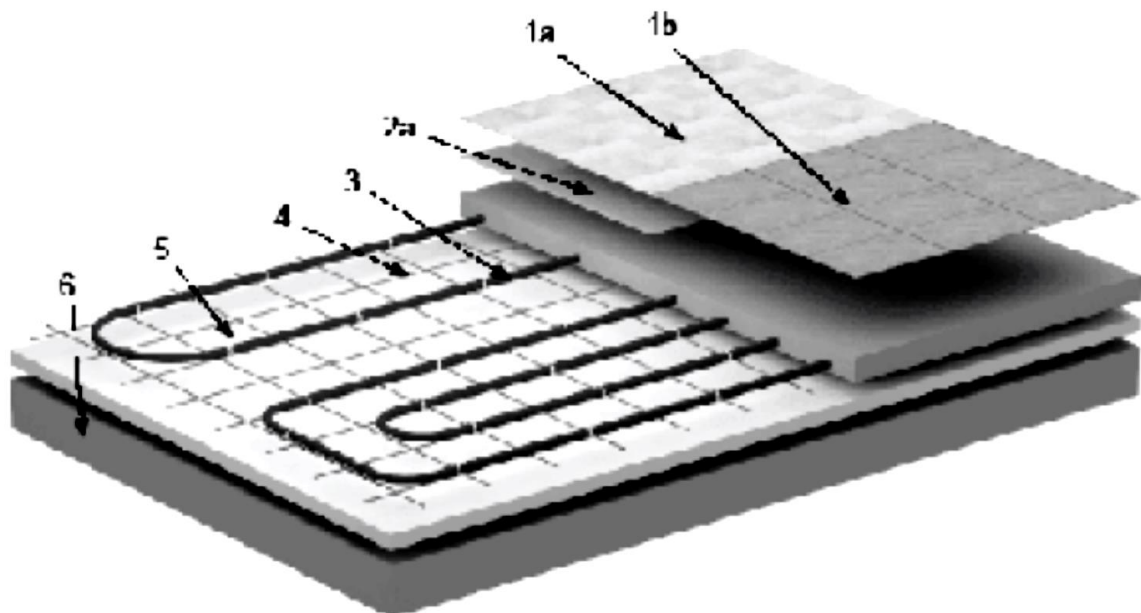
Спосіб укладки труб бетонної системи водяної теплої підлоги:
